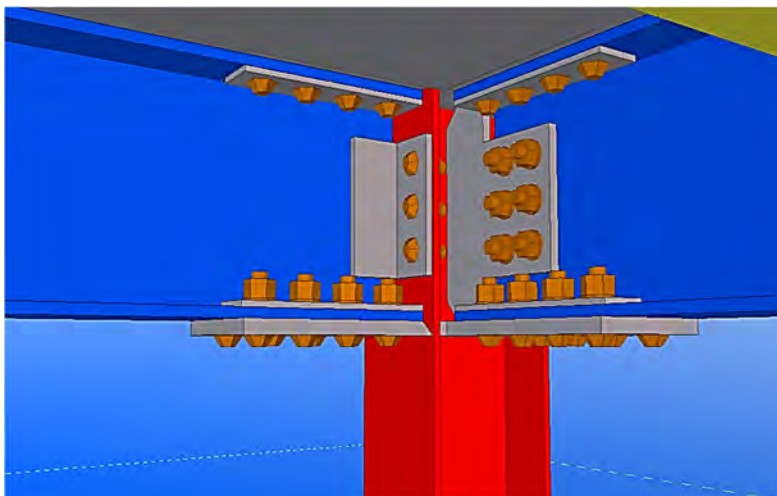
Conexión rígida tanto en patín como en alma de columna.
